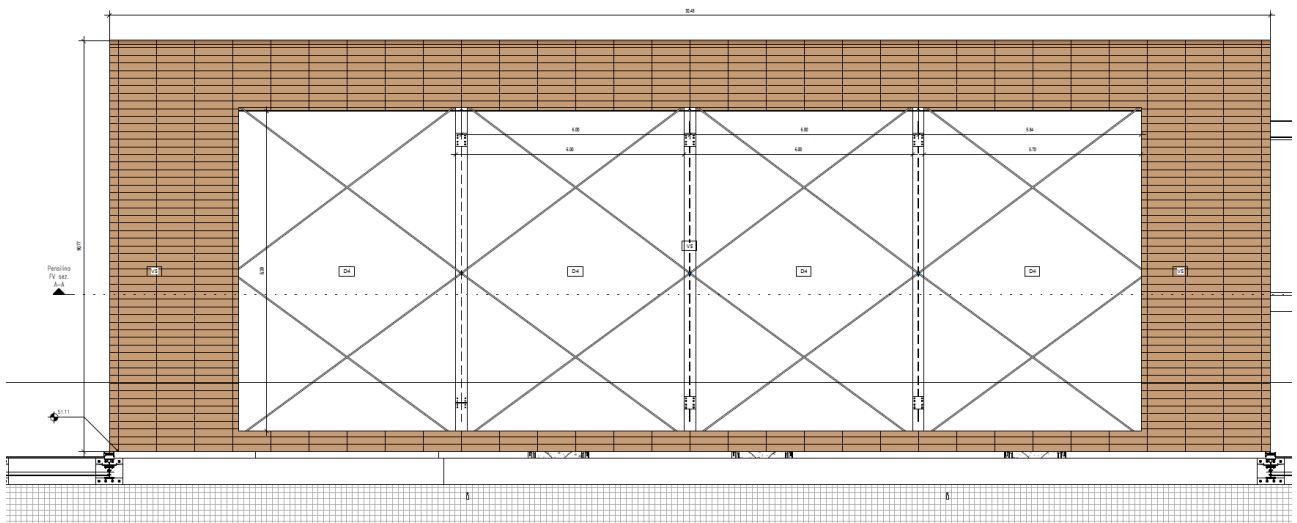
FV05 - Pensilina FV – pianta delle coperture
